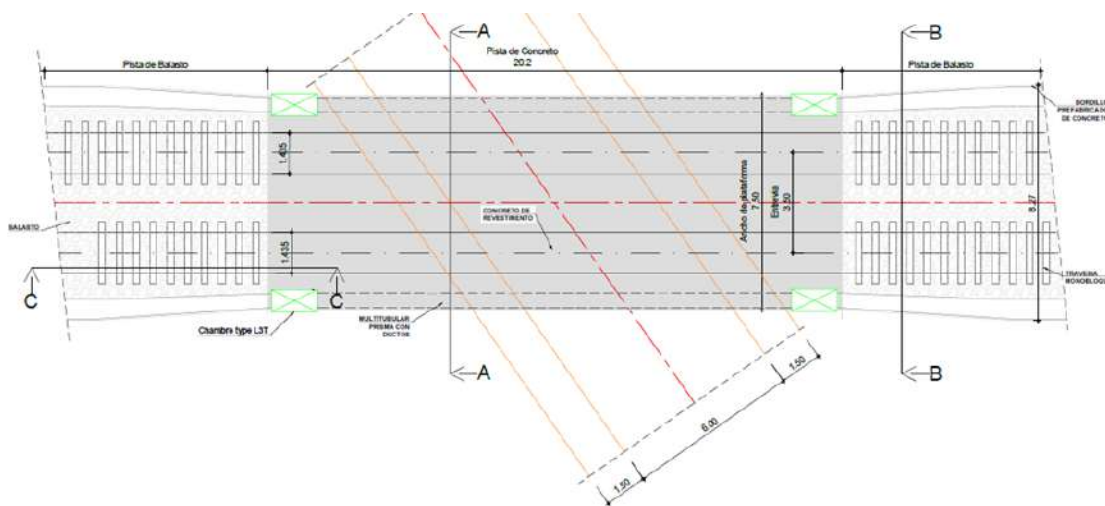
Ejemplo de elementos modulares en caucho o en concreto
